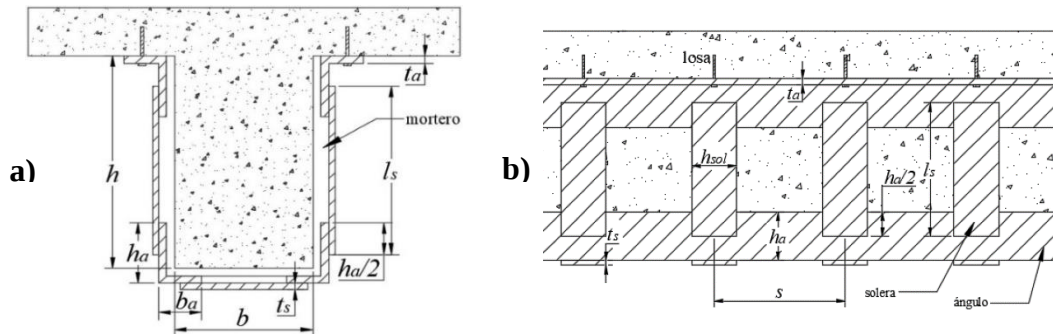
Encamisado con ángulos y soleras en vigas: a) sección transversal y b) sección longitudinal, adaptado de Alcocer et al. (2019).
